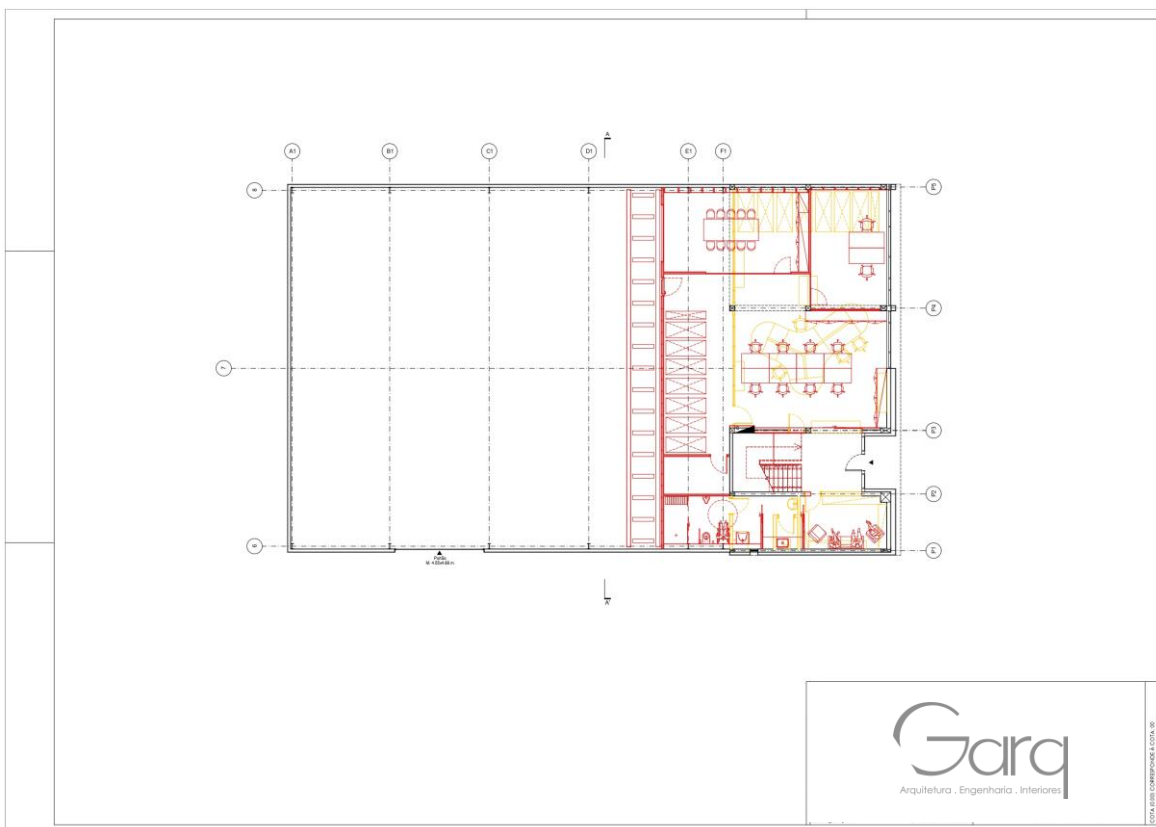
Vermelhos/Amarelos - Planta piso 0 (EXE_R00). Fonte: Garq / Desenvolvimento: Autora.
